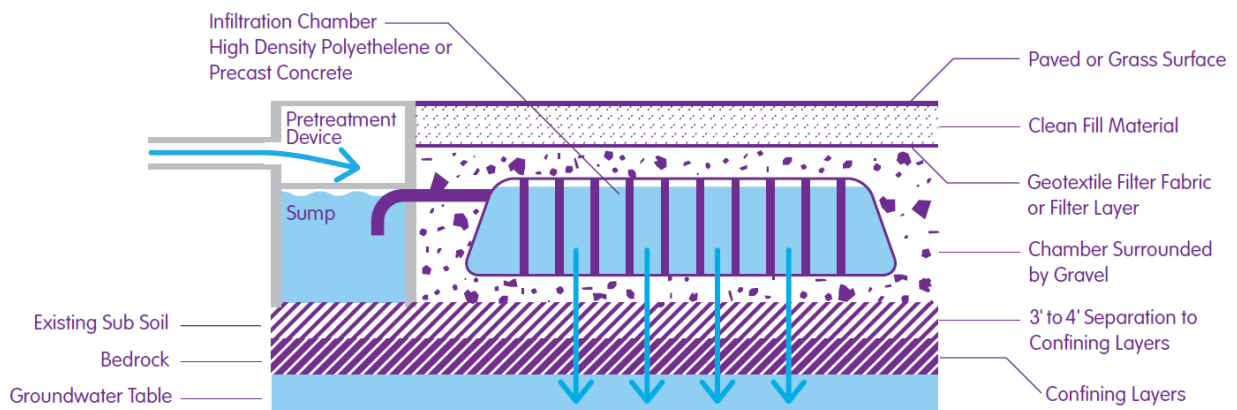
Poço de Infiltração com material poroso (NYC Department of Design and Construction, 2010)
